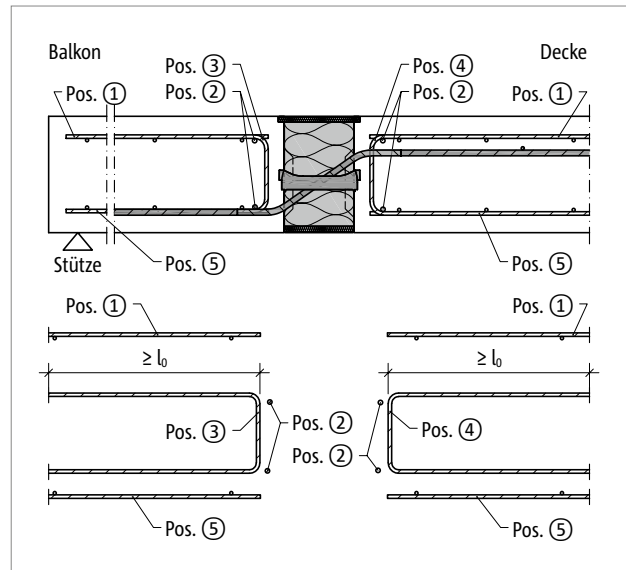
Schöck Isokorb® XT Typ QL-V5 bis QL-V11: Bauseitige Bewehrung
